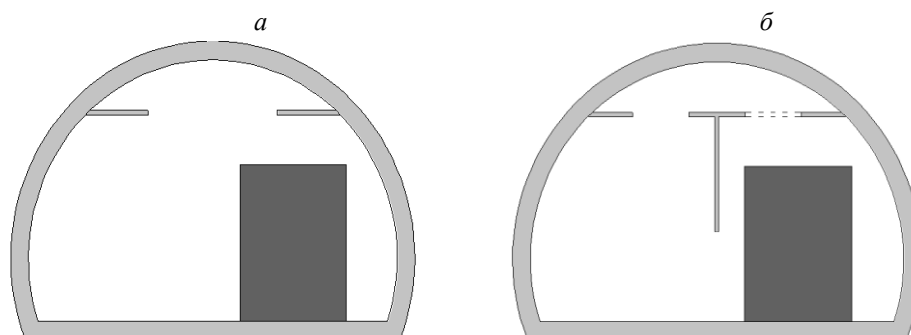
Двухпутный тоннель: *а* – с вентиляционным отсеком; *б* – то же с продольной перегородкой, разделяющей сверху объем путевого отсека
